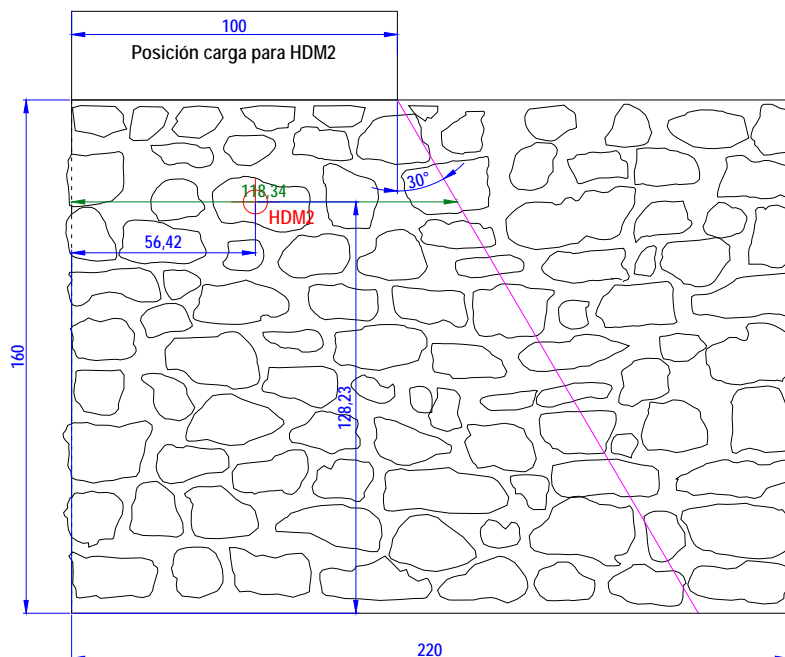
Alzado del muro de mampostería con la localización del HDM2. El espesor del muro son 31 cm. Las cotas referidas son cm.
